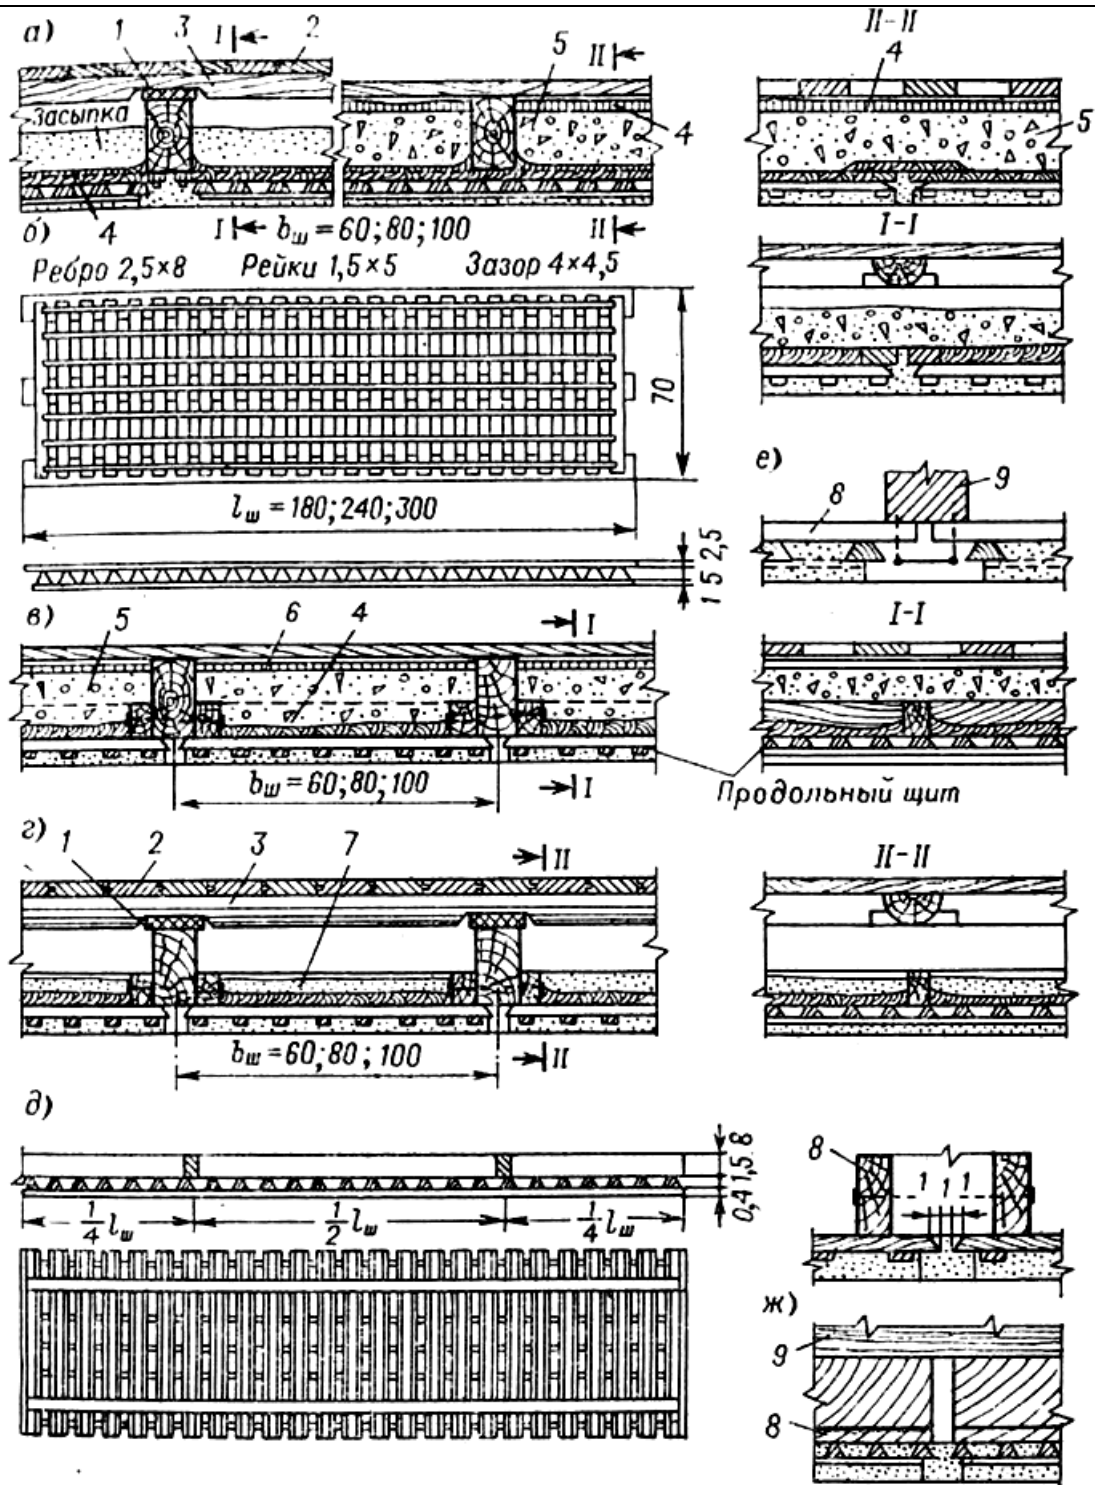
Перекрытие по деревянным балкам с щитовым накатом
